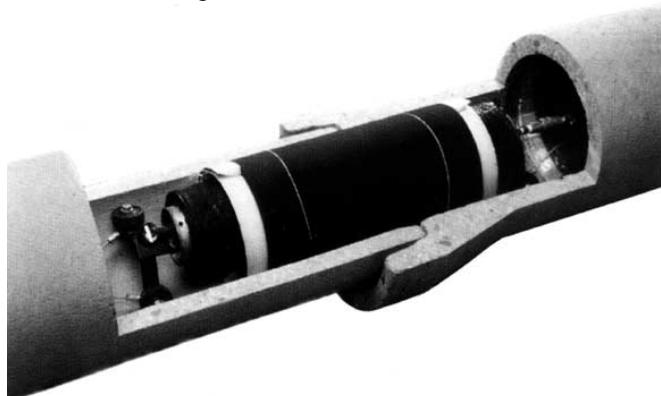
Фрагмент ремонтного участка трубопровода с установленной в нем ремонтной гильзой Grouting Sleeve.
